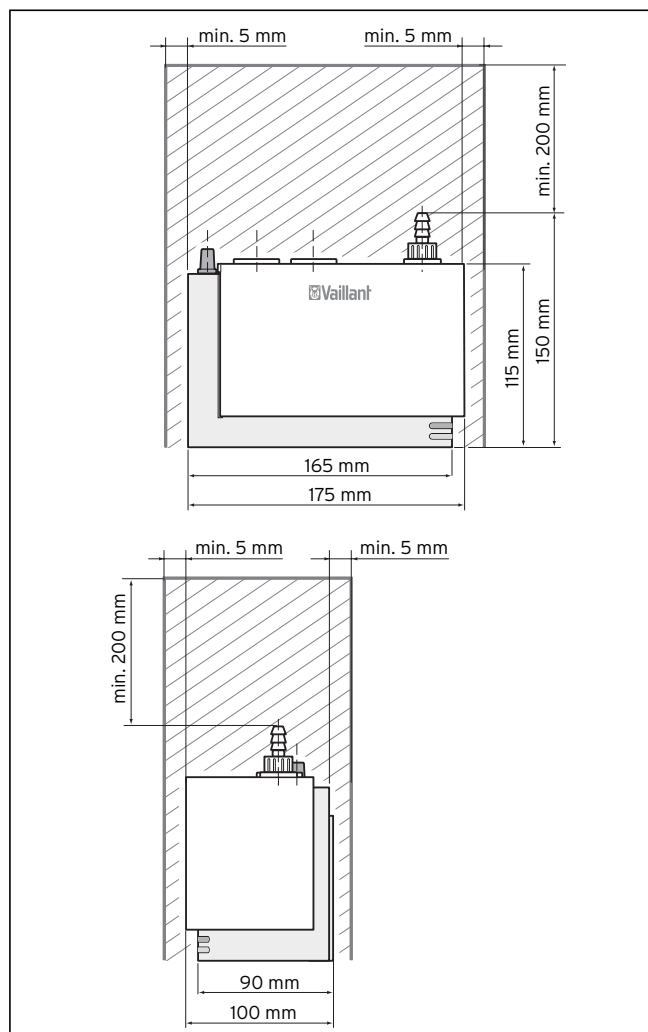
Dimensioni e spazi liberi per il montaggio
